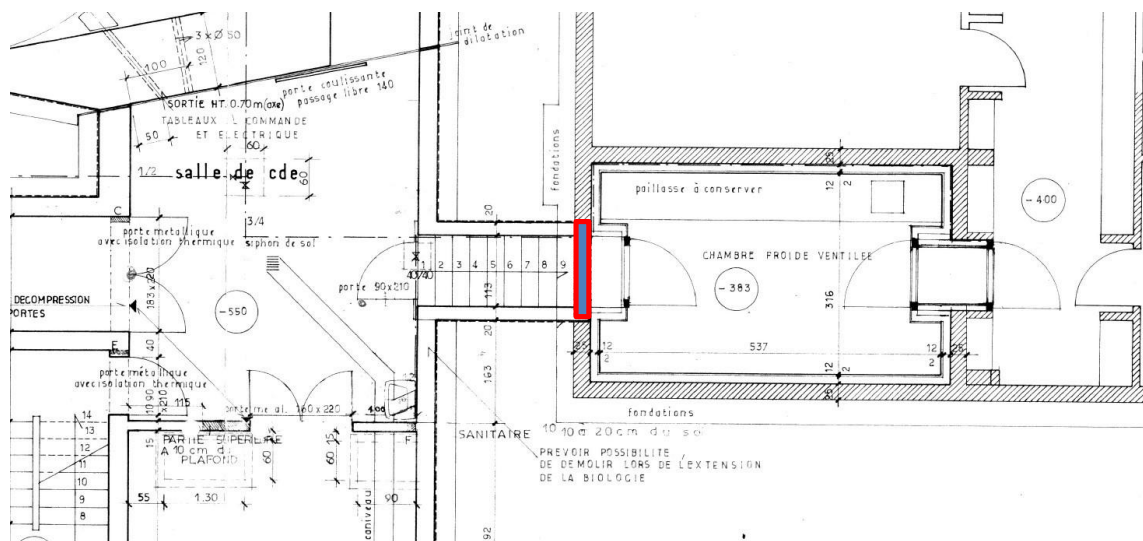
Implantation schématique fermeture de la porte CNB500-520 – Vue en plan
